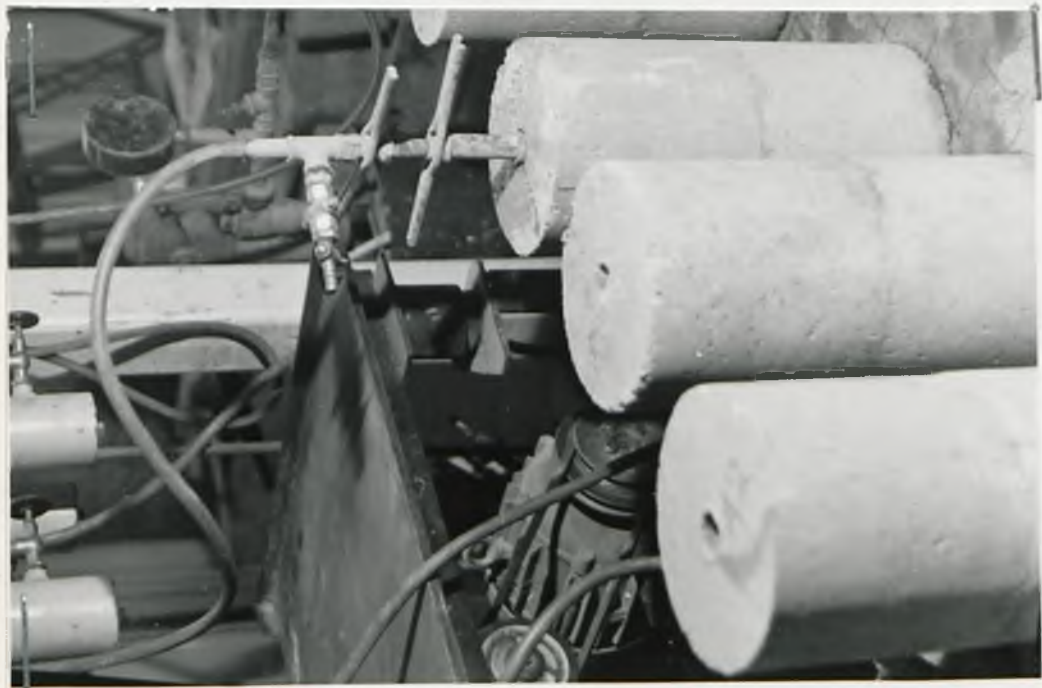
Próbki betonowe z przygotowaną powierzchnią do tłoczenia wody.
